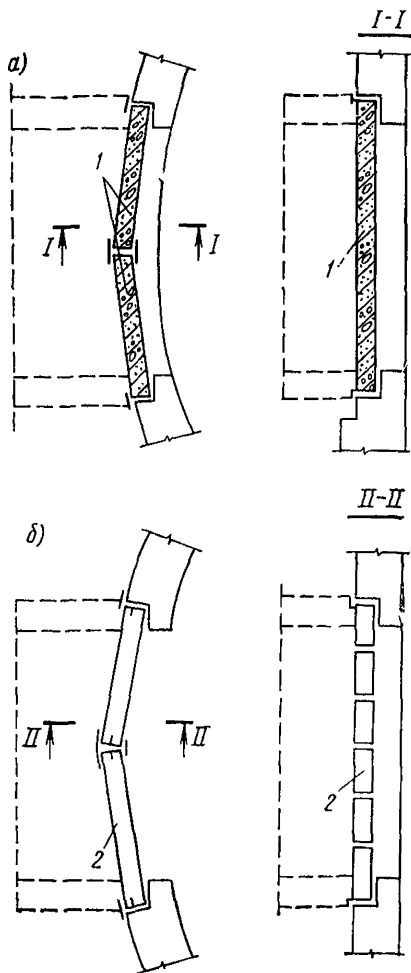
Примеры решений закладки проемов в стенах железобетонными панелями (а) и стальными щитами (б)
